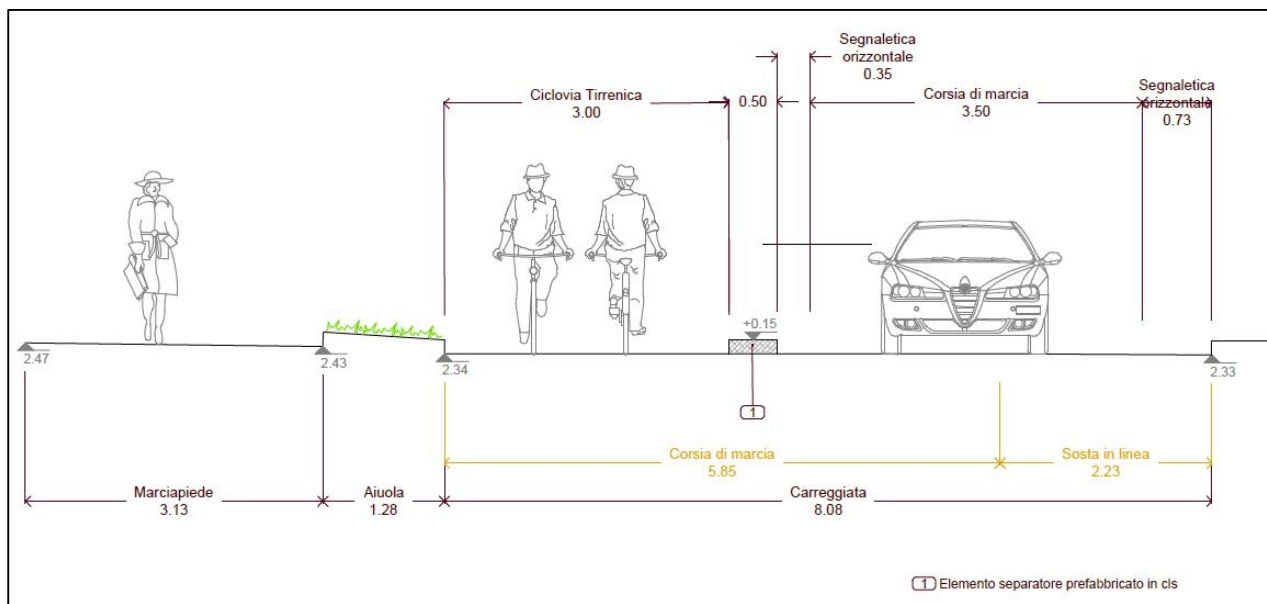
Sezione 06 di progetto trasversale su Viale Carducci
